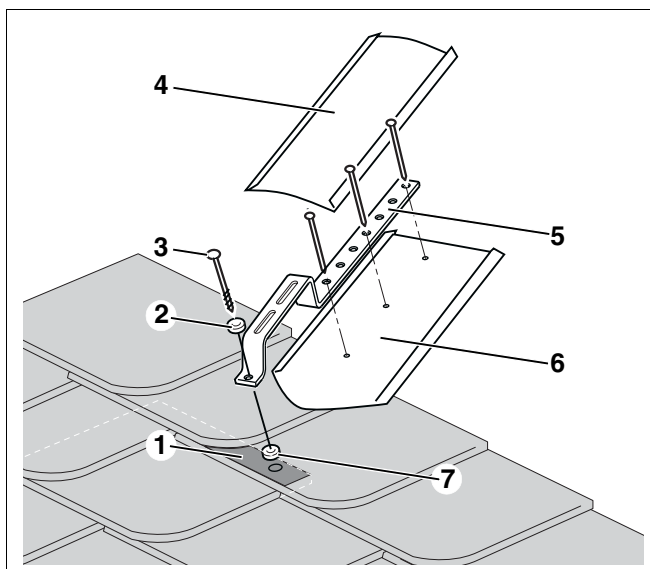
Gancho especial de tejado montado sobre una cubierta múltiple
